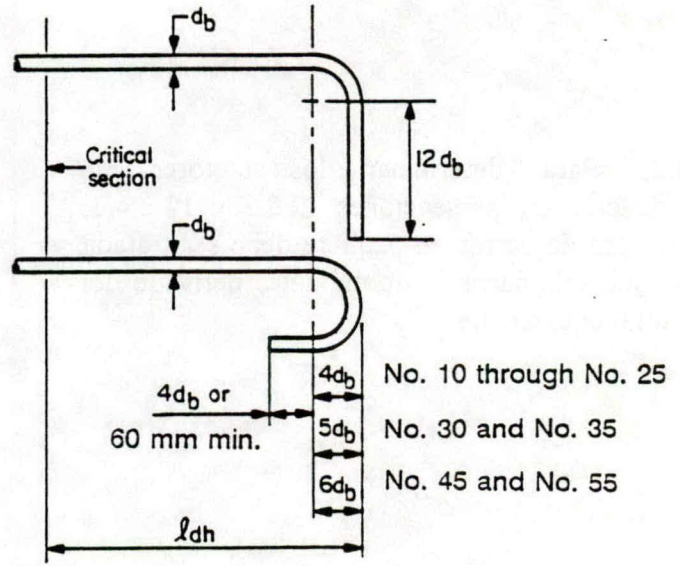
Detalles de barra dobladas para desarrollar el gancho estándar.
